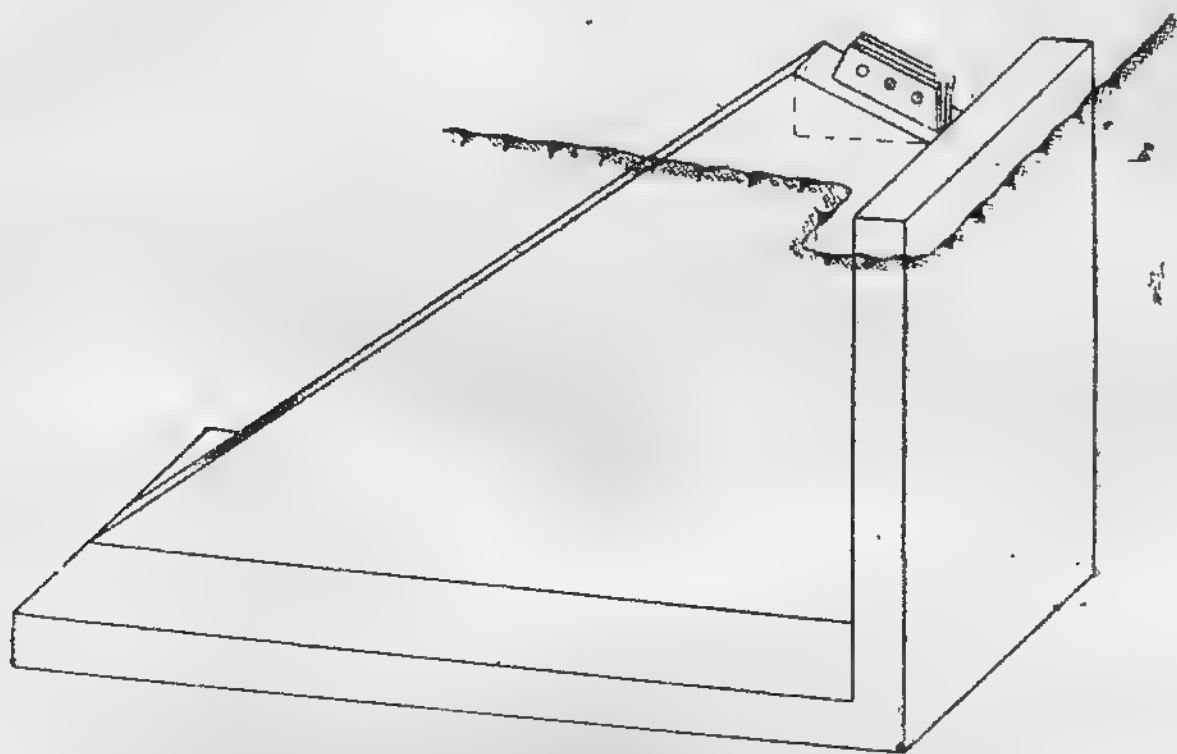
Железобетонный анкер для крепления оттяжек мачты.
